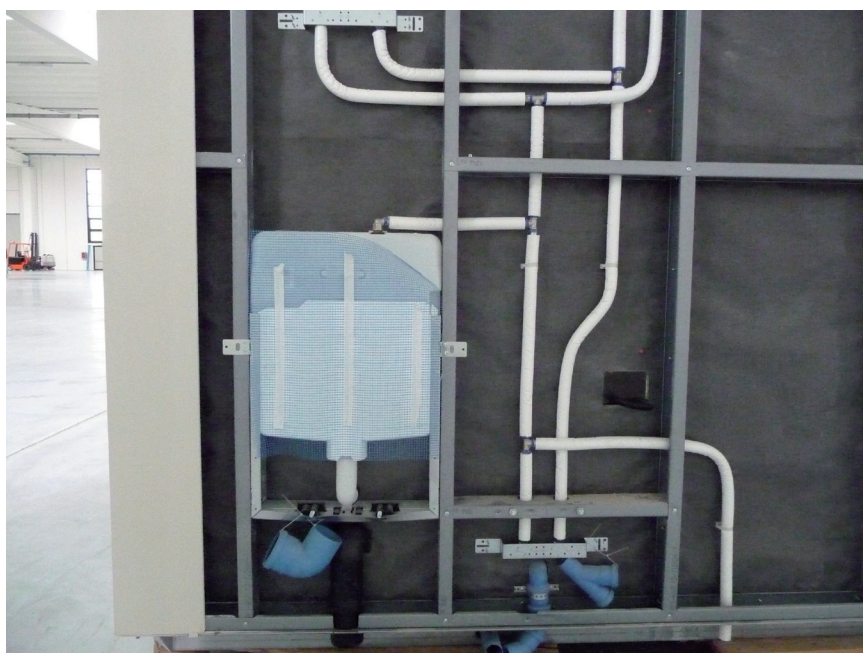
Esempio applicativo del passaggio degli impianti all'interno di un telaio Lightweight Steel Frame. Un'attenta progettazione permette di produrre in maniera puntuale i fori dei profili (per numero, dimensione, posizione). *Immagine dell'autore.
